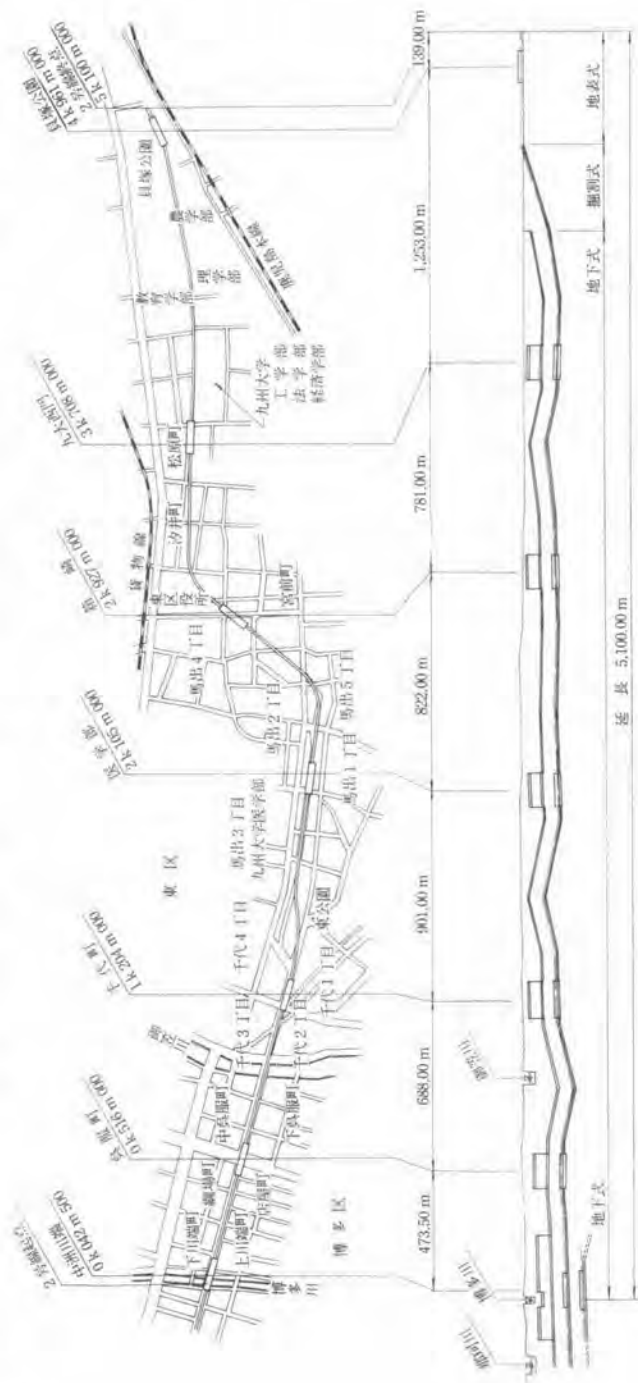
2号線中洲川端~貝塚公園間平面および縦断面図
